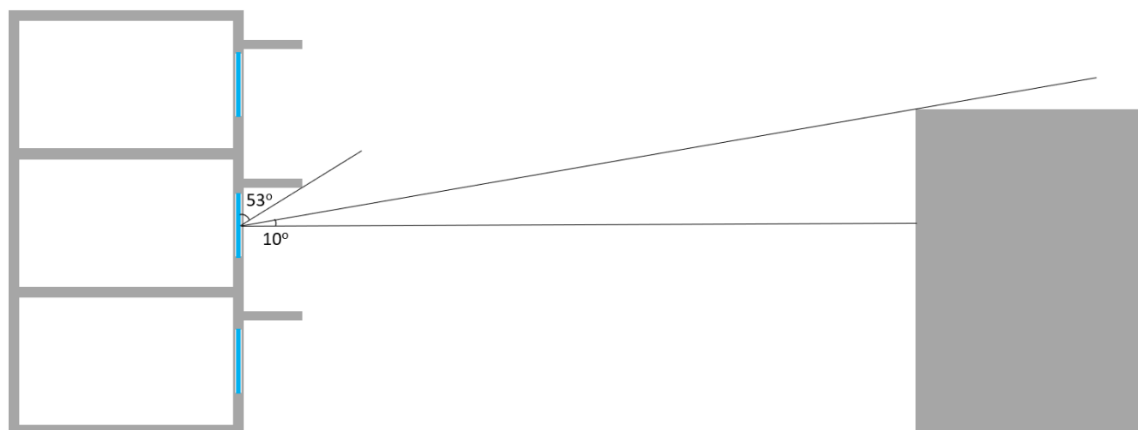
Ângulos de obstrução (na estação de aquecimento).
